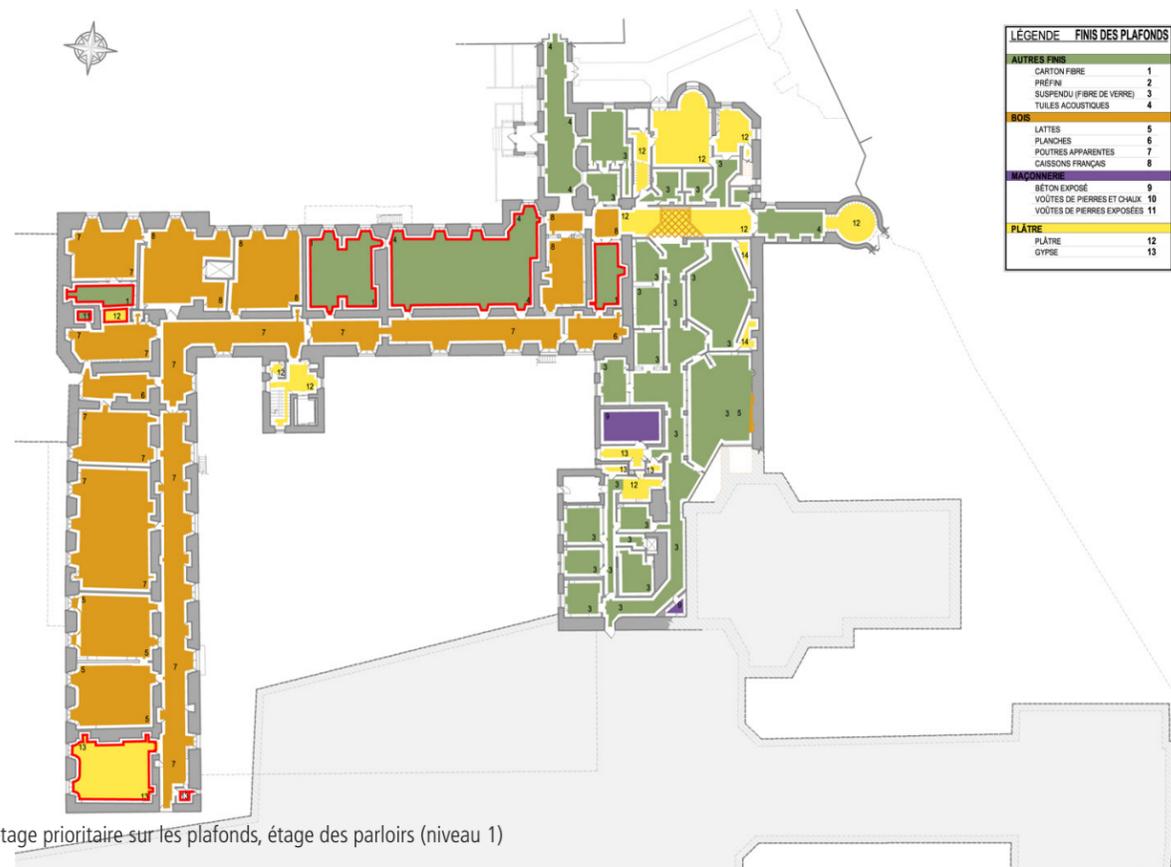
Plan de curetage prioritaire sur les plafonds, étage des parloirs (niveau 1)
